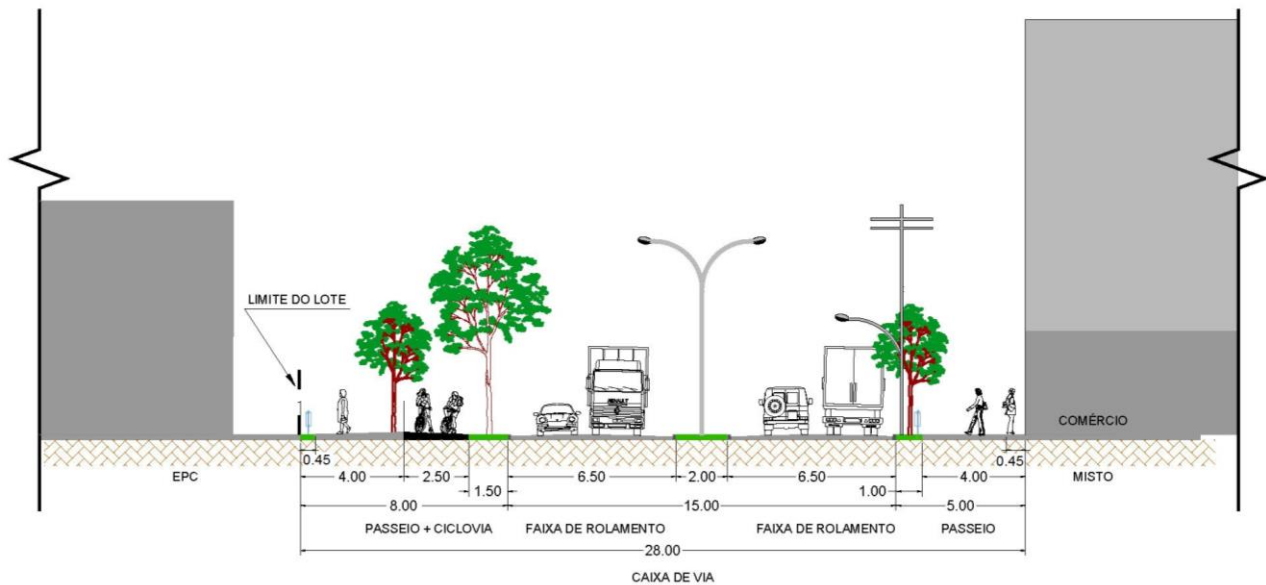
Corte esquemático da Avenida Crixá em trecho com caixa de via mínima.
